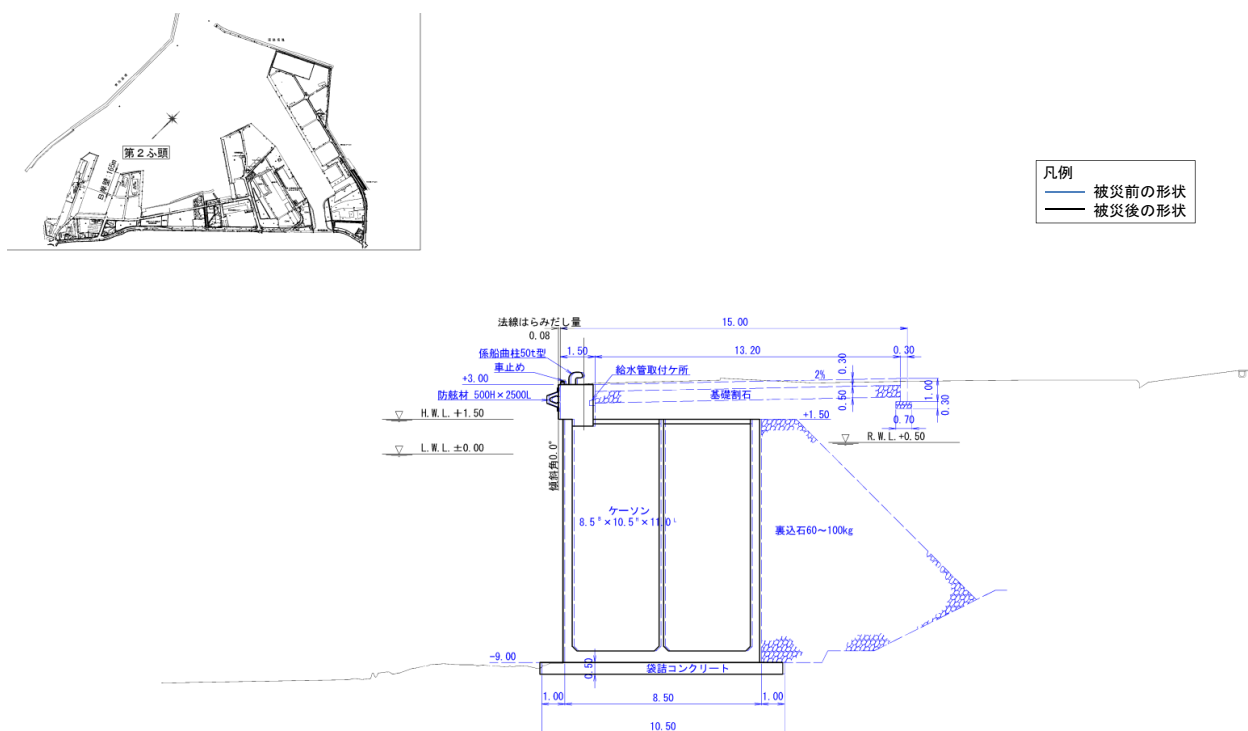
No.5 日立港区\_第2埠頭地区 2-B岸壁（-9m）の断面図（被災前・後）
